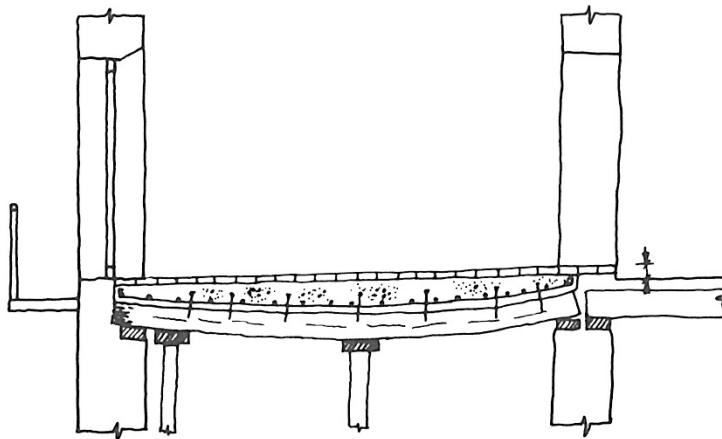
Aplicação duma camada de betão armada na face superior do pavimento. Arriaga [1]
